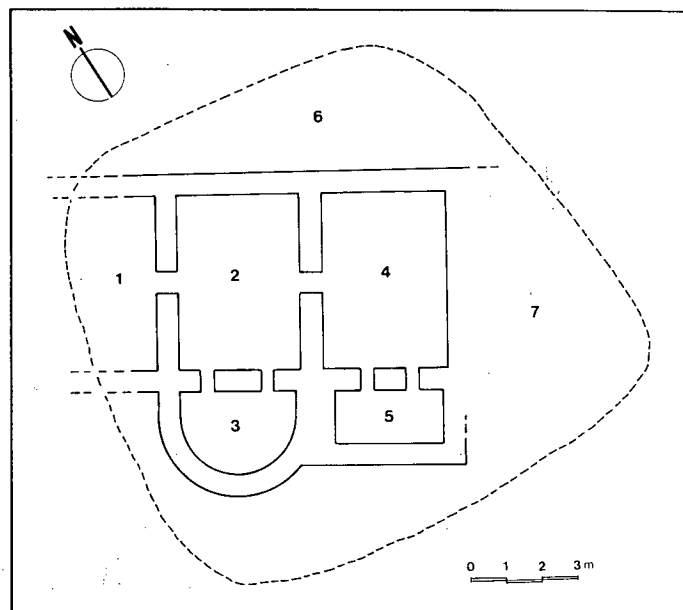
EYGUIERES, Saint-Pierre de Vence. Plan schématique des constructions découvertes sous le pierrier (contour en tireté).
